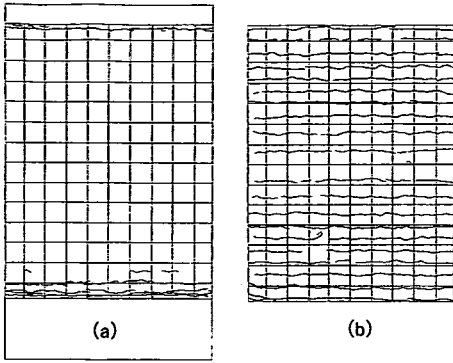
岩着試験体のひび割れ状況（東側壁）
